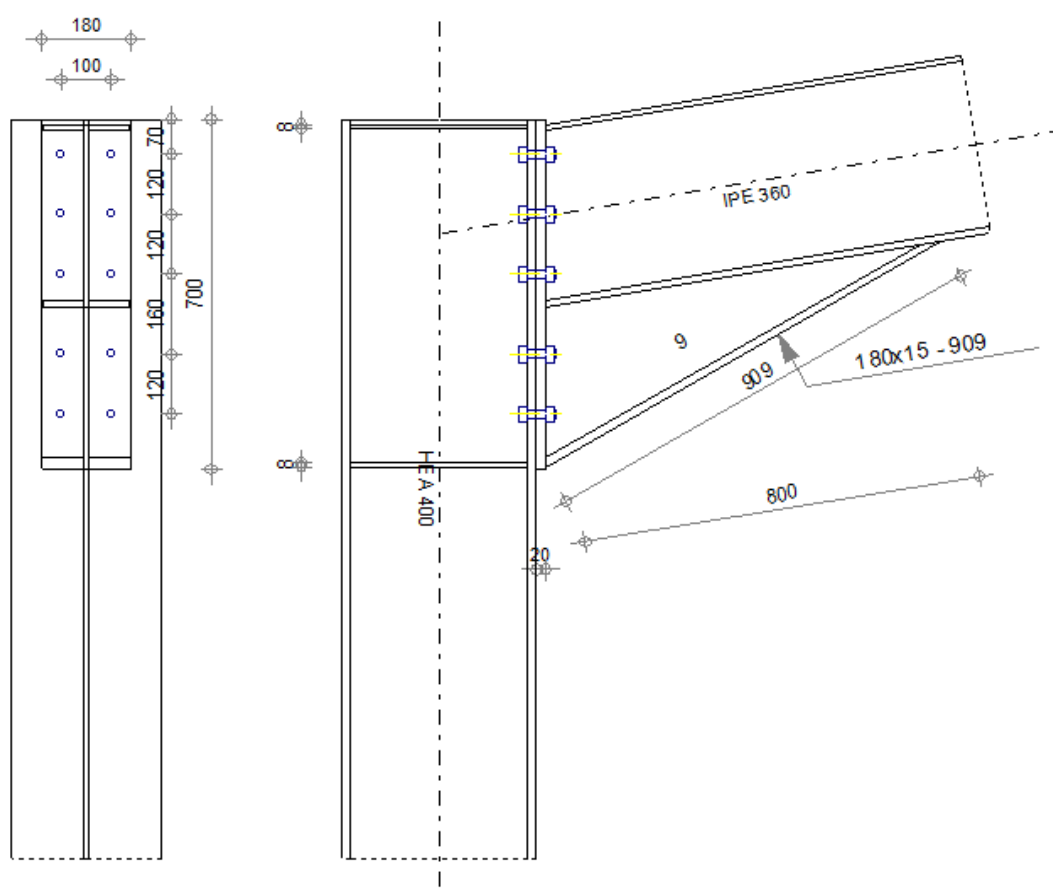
vue en plan de l'assemblage poteau-traverse.
